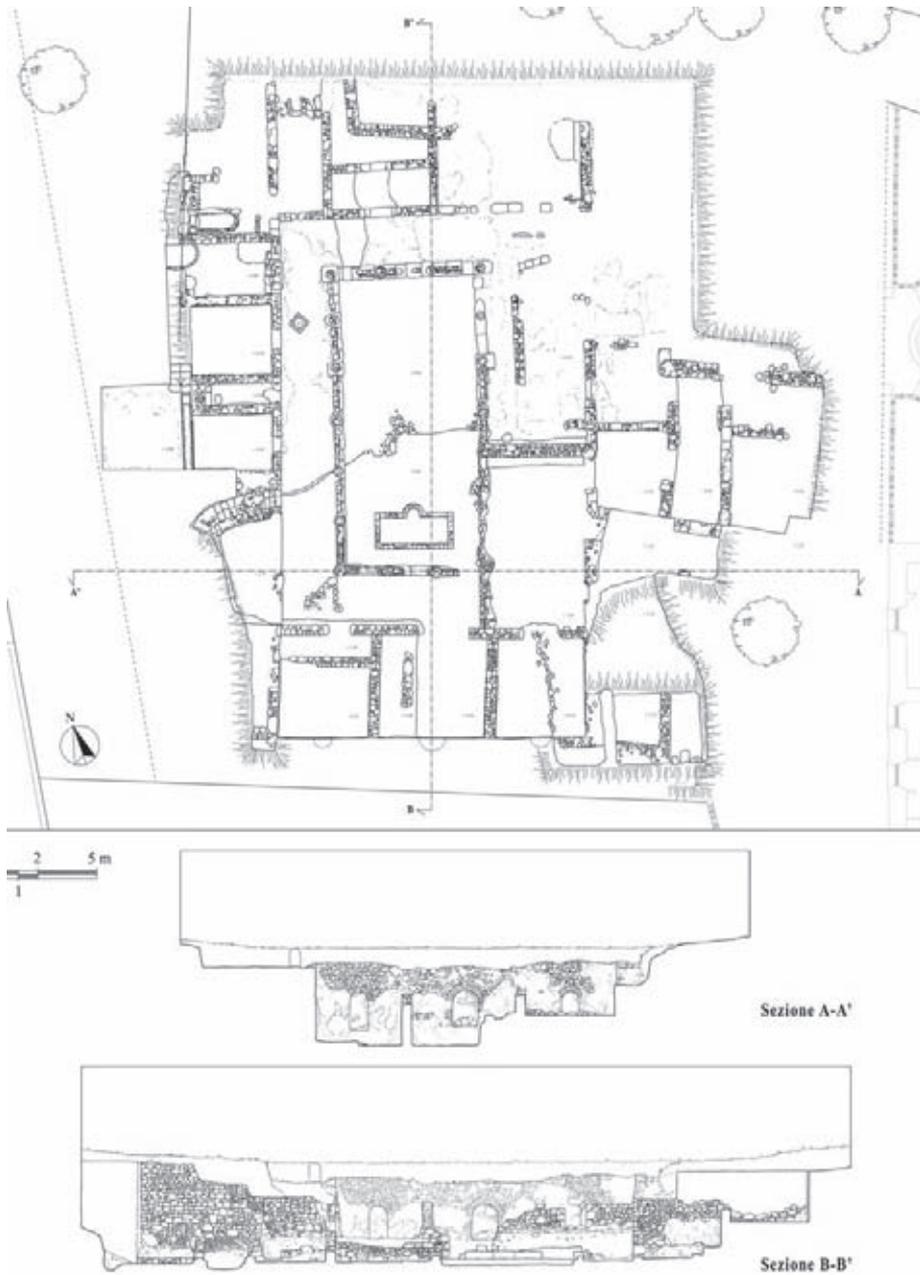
Pianta della Domus con le creste murarie e sezioni-prospetti morfologici.
